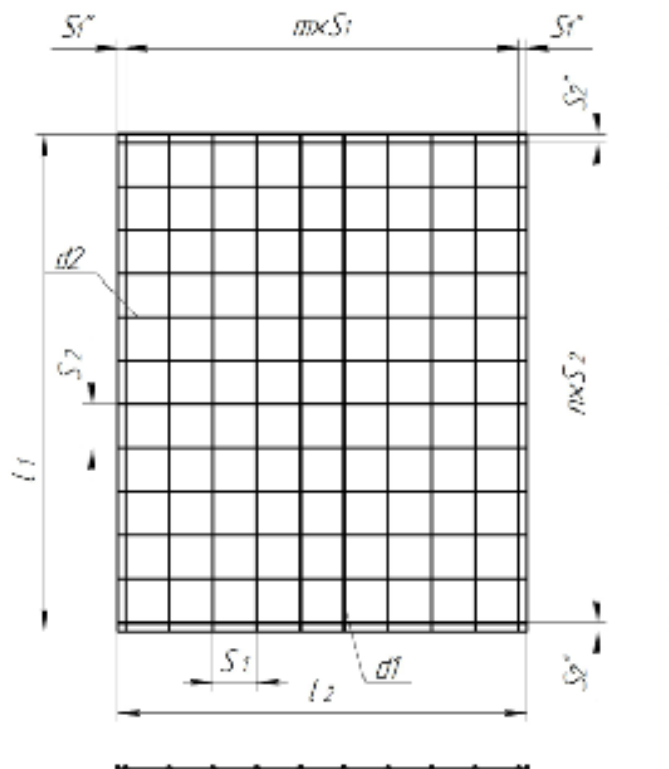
Пример вида и обозначений геометрических параметров симметричного стандартного сварного каркаса со стержнями, сдвоенными по периметру
